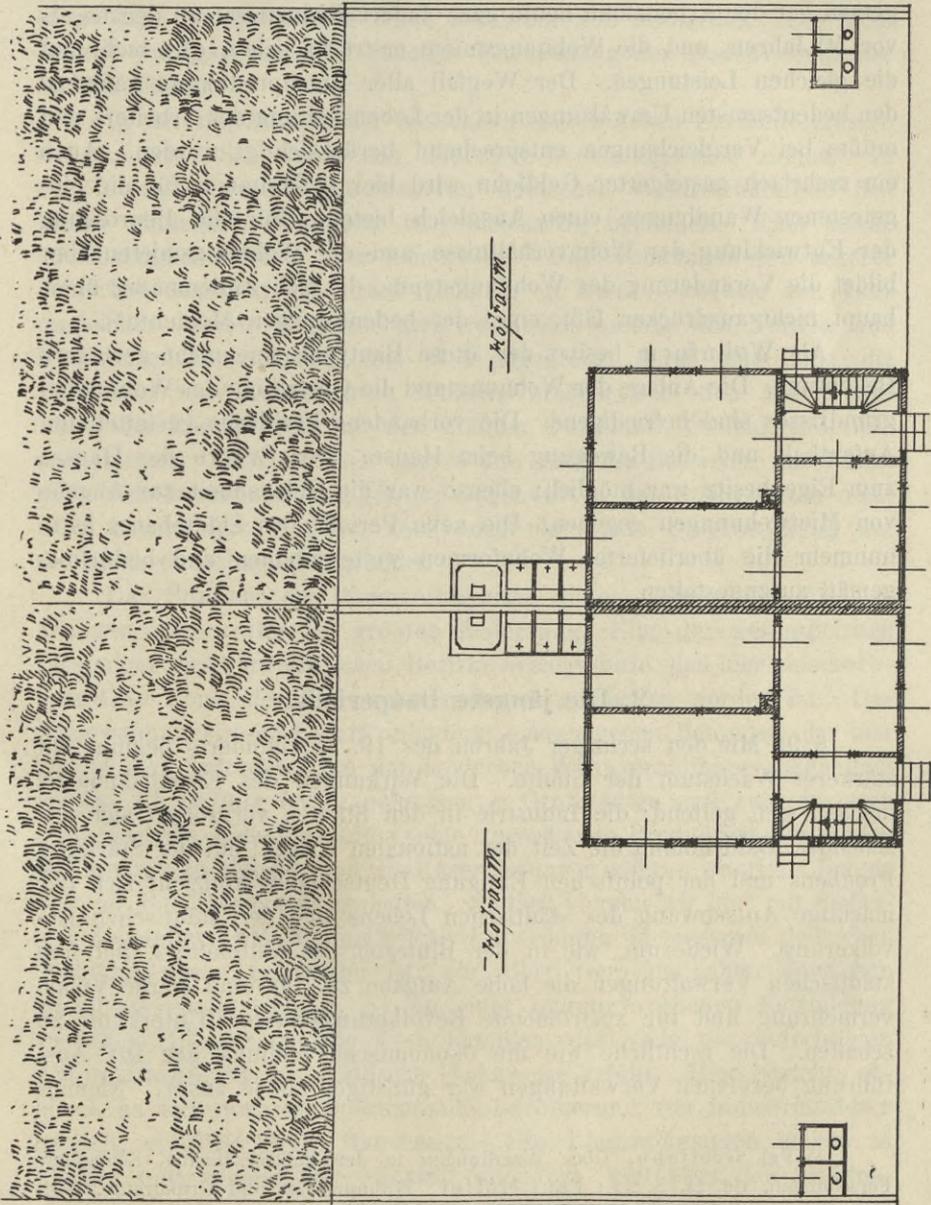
Grundriß, Erdgeschoß zu Abb. 14.
